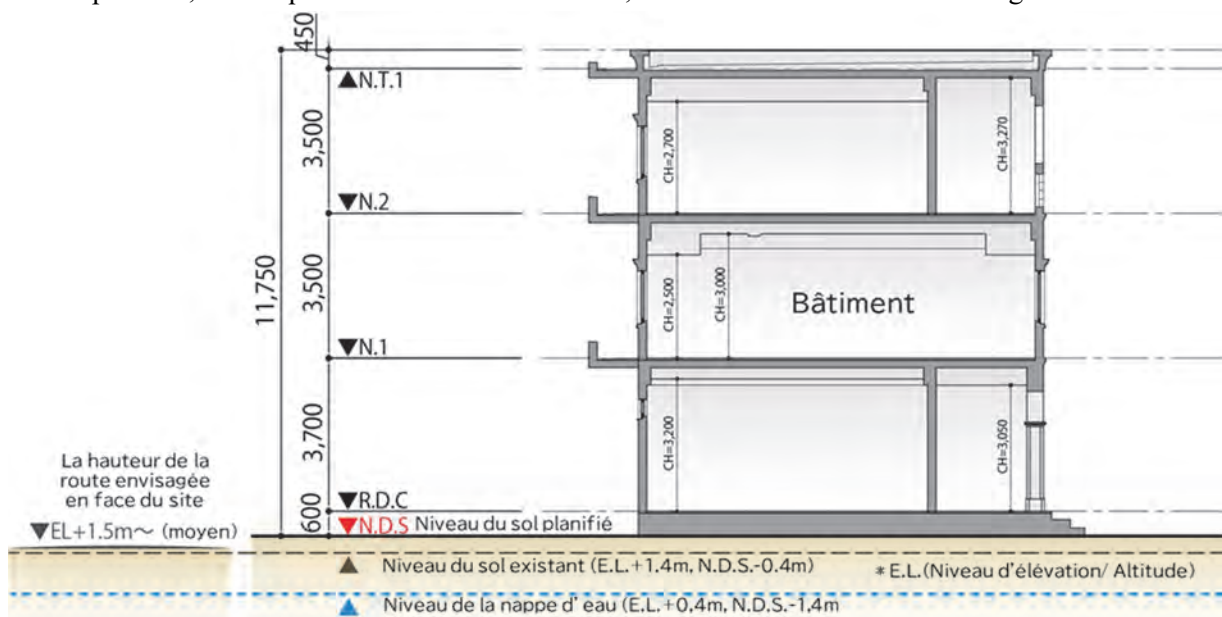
Diagramme de corrélation entre le niveau du sol, la hauteur de plancher et la hauteur d'étage.
